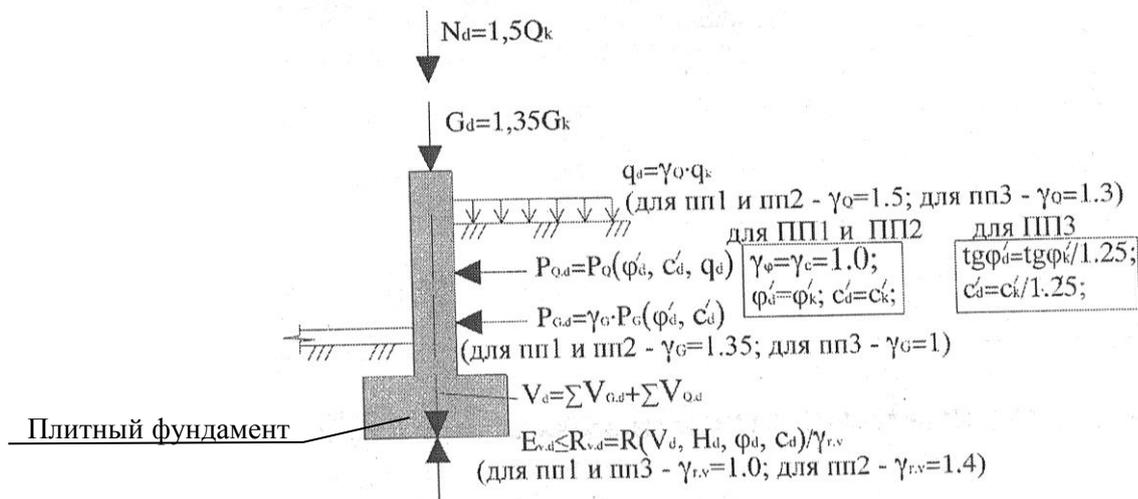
Принципы подходов ПП 1 – ПП 3 (ДА 1 – ДА 3) к проектированию плитных фундаментов с использованием частных коэффициентов (вариант вертикального равновесия при неблагоприятных сочетаниях воздействий)
